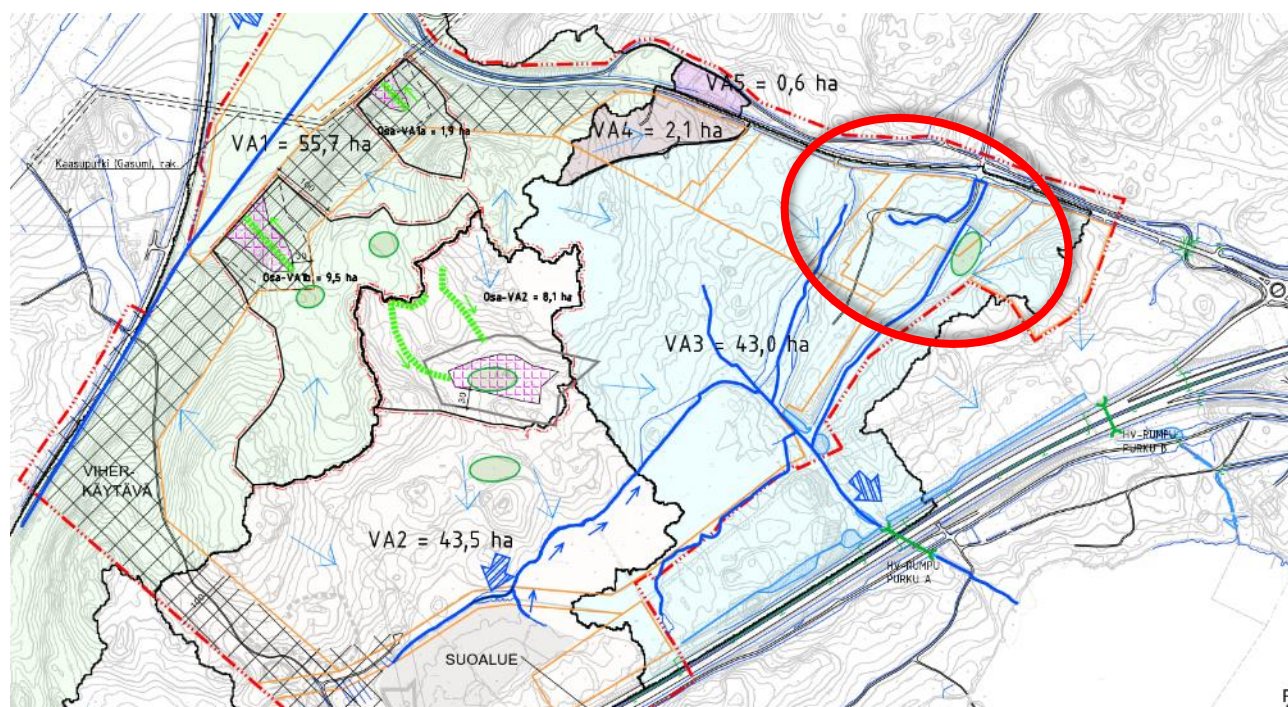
Utdrag ur dagvattenplan. Planeringsområdets läge med en röd ellips. Ej i skala. Källa: Dagvattenutredning, nuläget, planritning 1:2 500, Ramboll Finland Oy, 12.5.2020.
